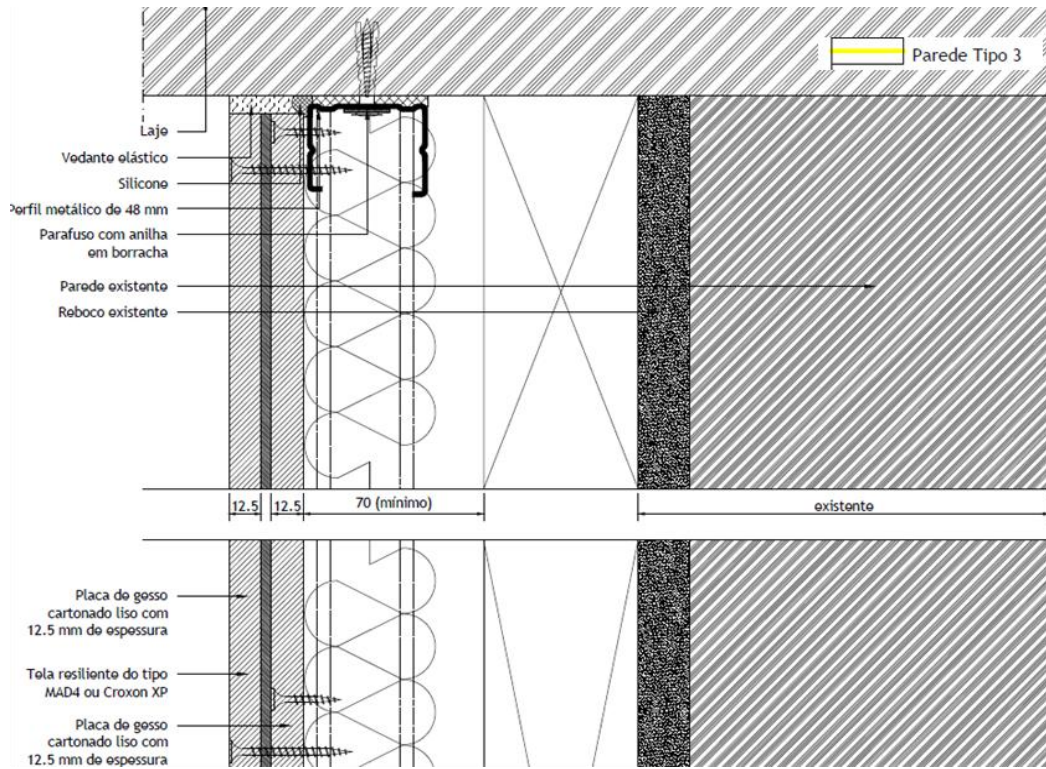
Corte construtivo da parede tipo 3 da Escola Secundária de Gondomar [53].
